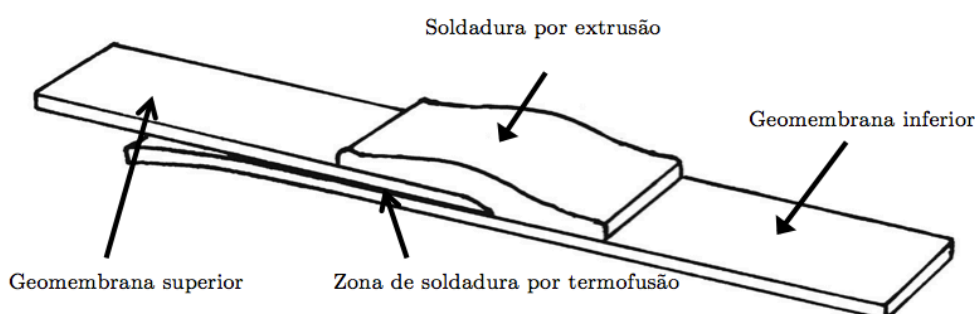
Soldadura extrusão (adaptado de (Müller, 2007)).
